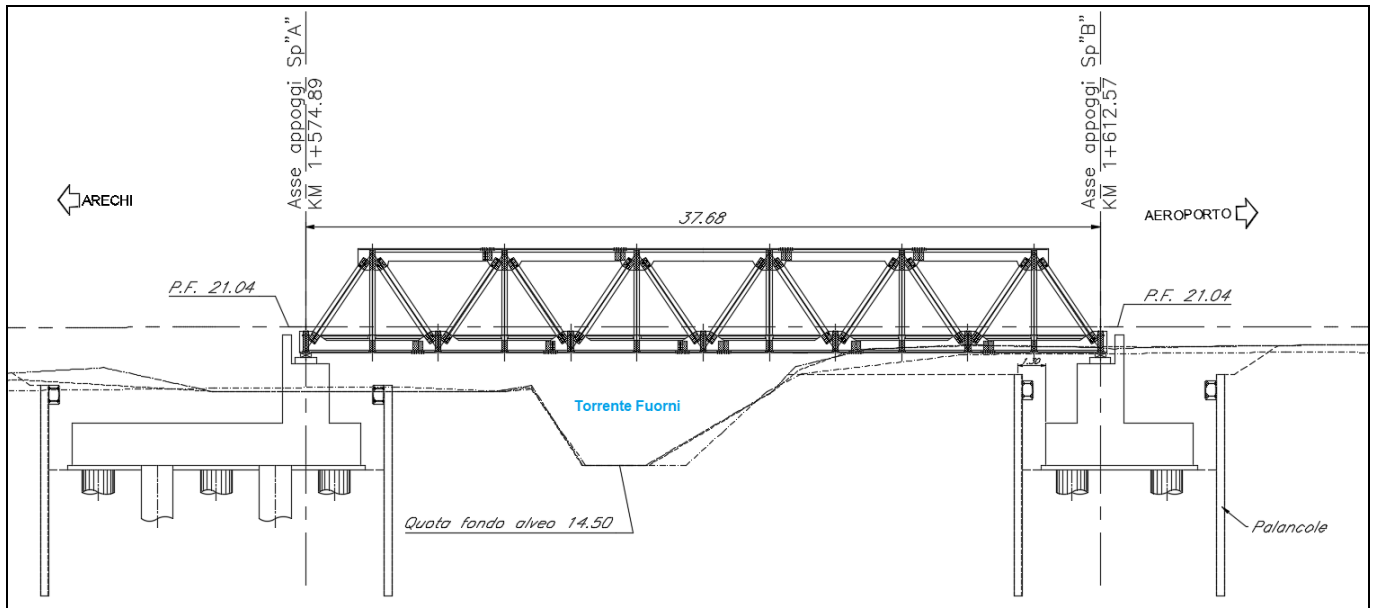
Viadotto VI01 sul Torrente Fuorni: prospetto.
